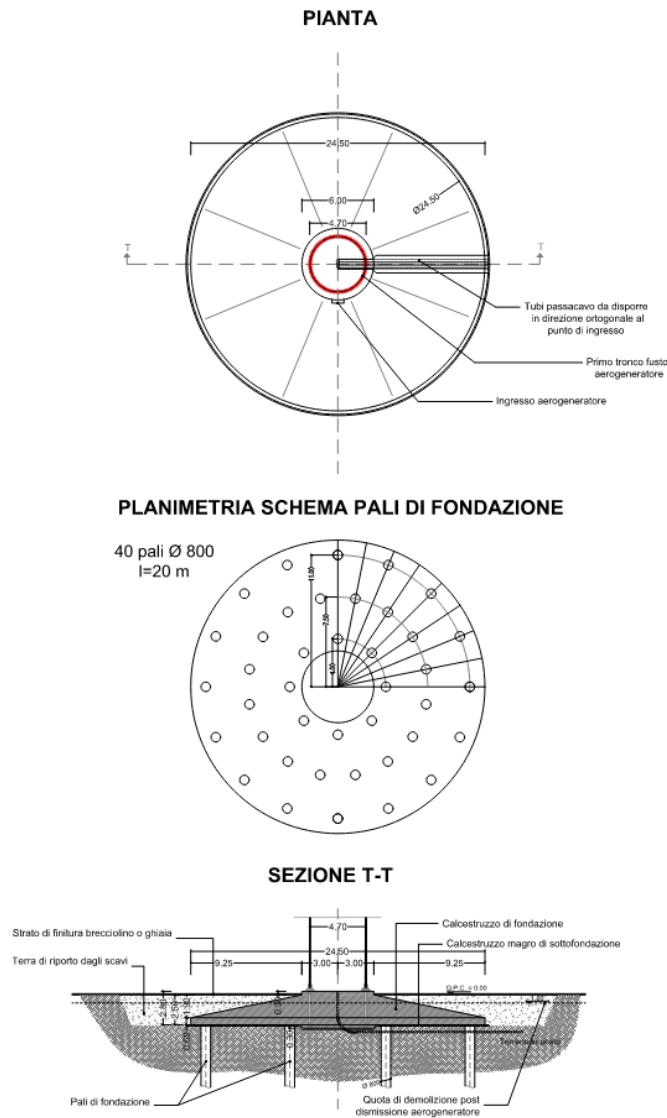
Schema costruttivo eventuale fondazione su pali
